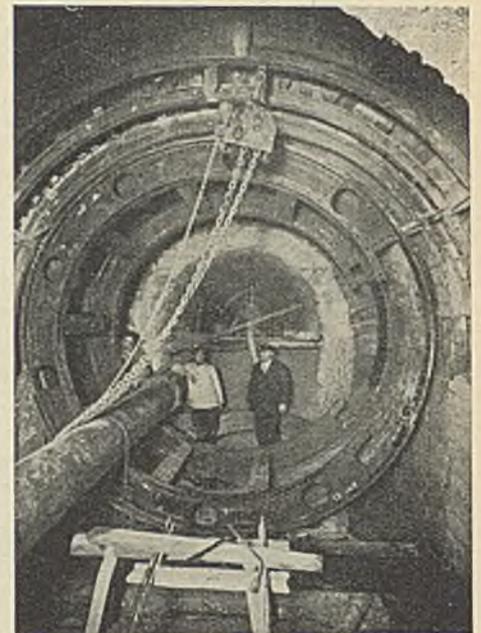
Schildmontage, im Hintergrunde betonierete Stollenröhre, Fangdamm und Ableitung des Wassers durch Luttenrohr.
